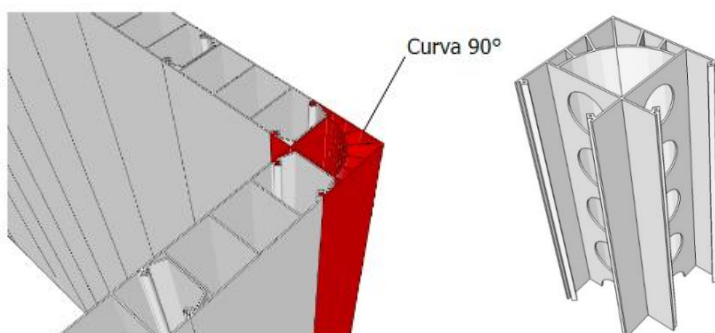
Perfil “Curva de 90°” utilizado em ligações entre paredes do tipo “L”. (Sem escala).
